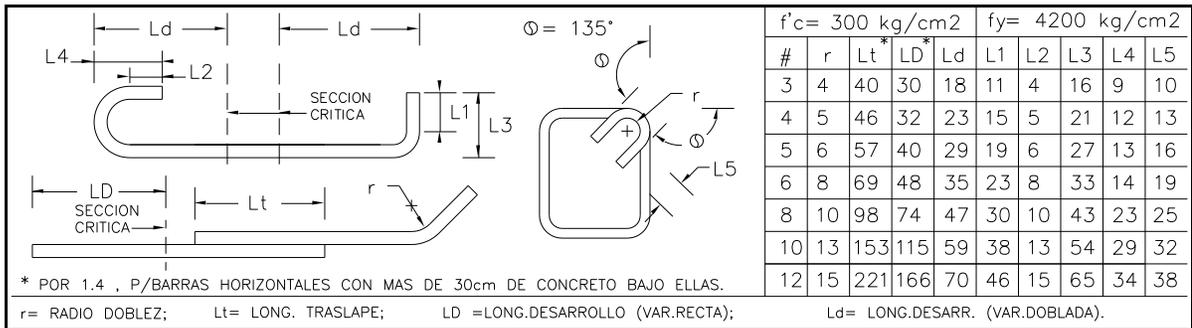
Detalles de Refuerzote de anclajes y traslapes.
